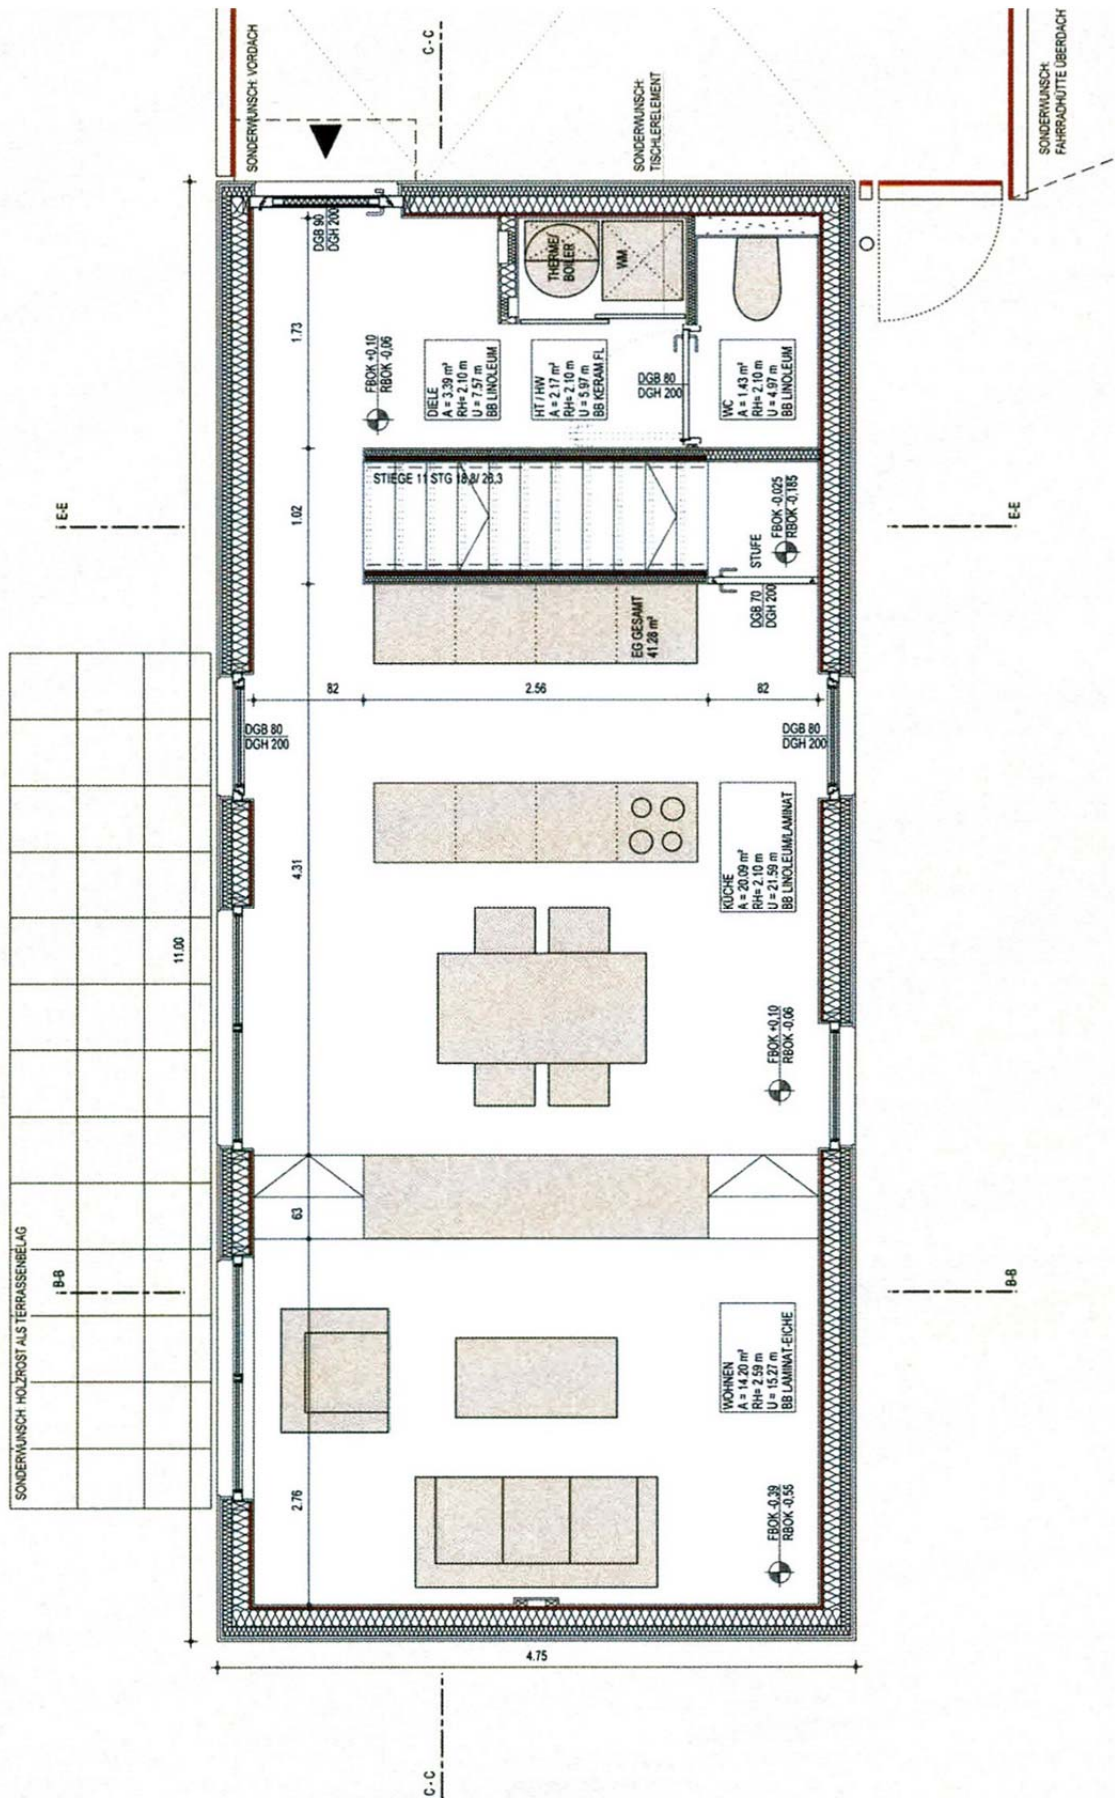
Grundriss Erdgeschoss_ Typ D mit Keller
